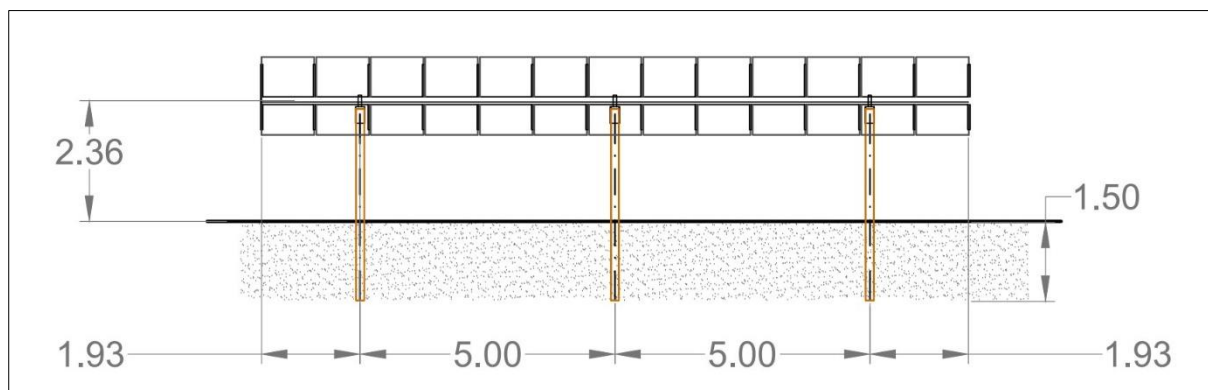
Stralcio prospetto struttura di supporto 2x13
